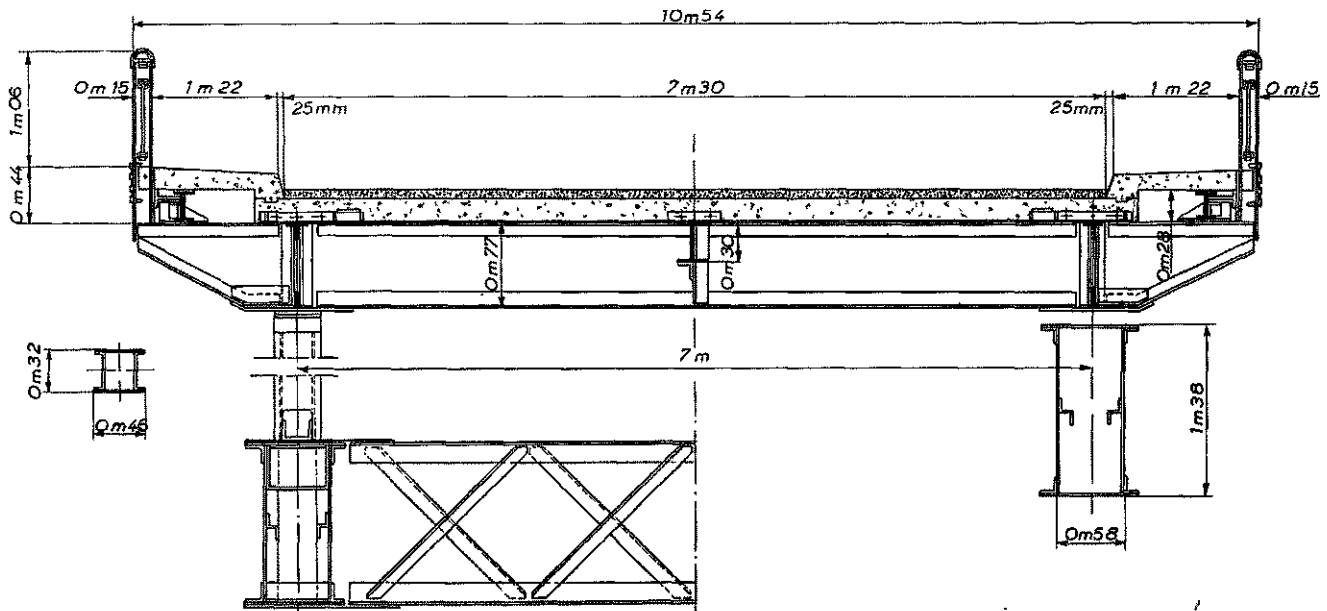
Coupe dans le tablier du pont montrant les poutres longitudinales portées par les arcs, recevant la chaussée en béton et les dalles des trottoirs.
